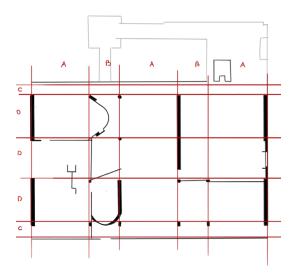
Dibujo de la autora sobre la retícula de la Villa Stein.
